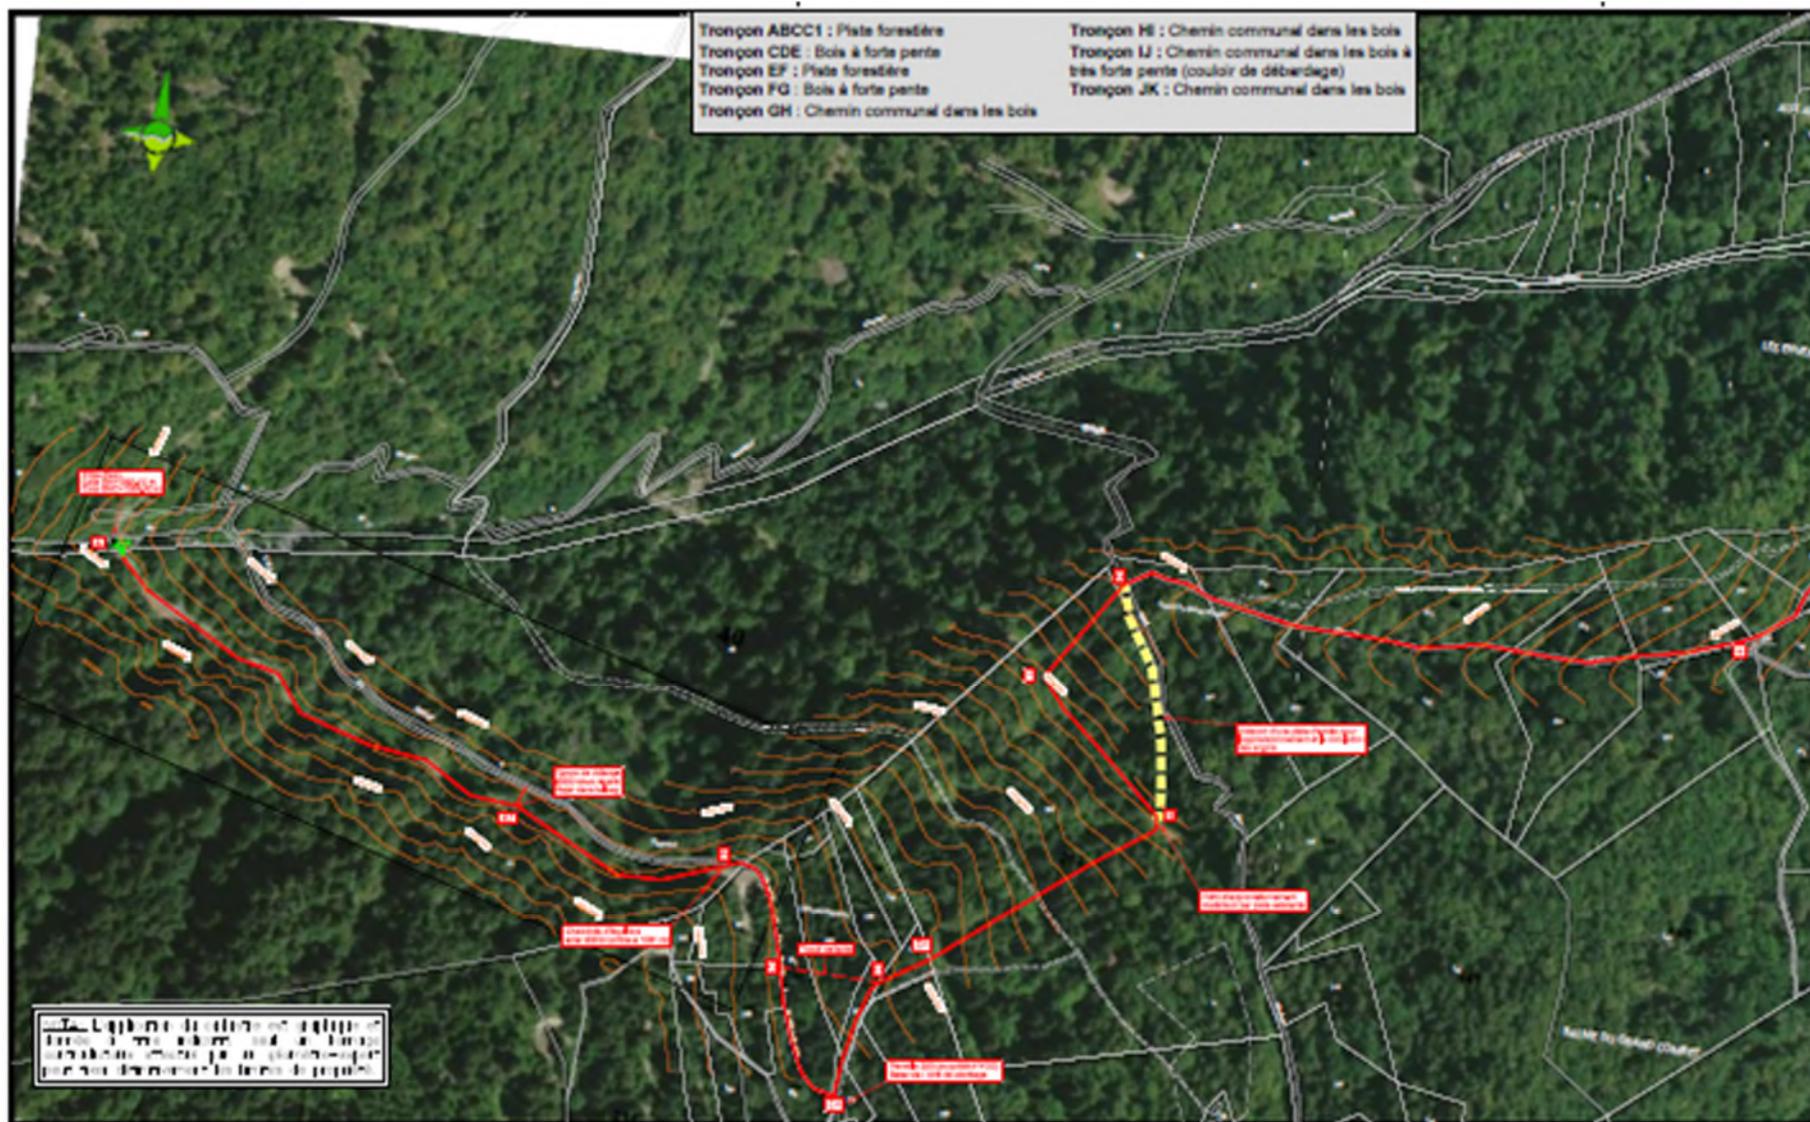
Vue en plan de la conduite forcée (tronçon A – H) (source : Profils études et Hydrostadium) (cf Annexe 4 page 431 : plan disponible au format A0)
